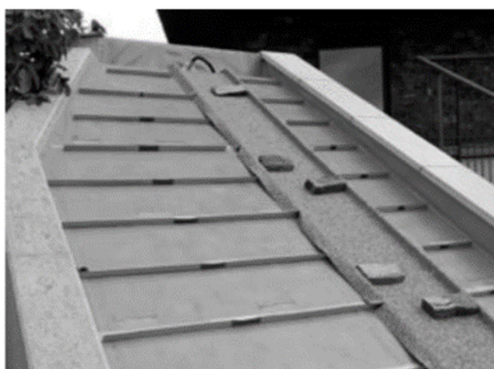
Drátěný drenážní systém s ochranou [6]
